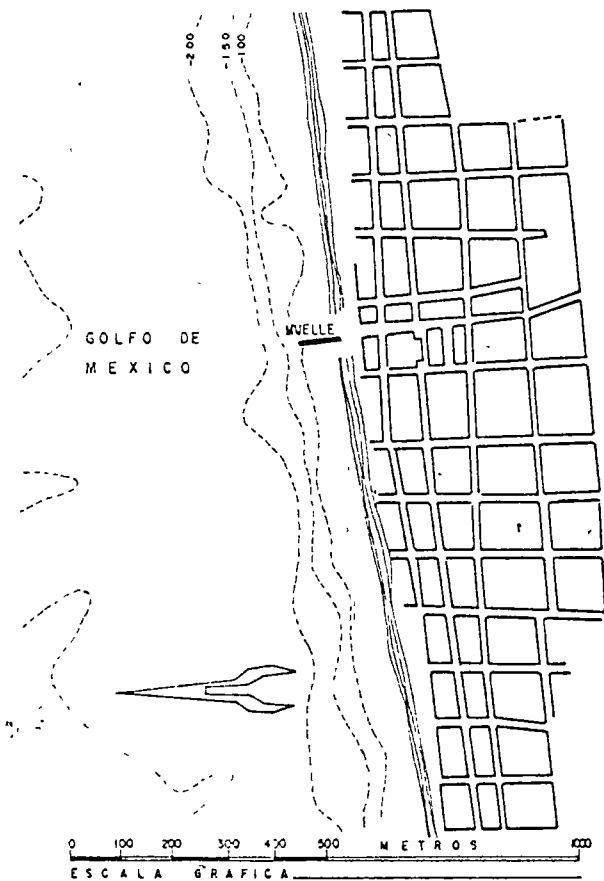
Planta de Telchac Puerto y localización del muelle.
